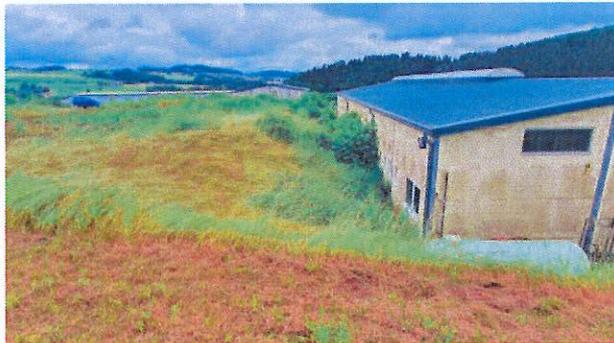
Einschnittsböschung im nordwestl. Plangebiet
